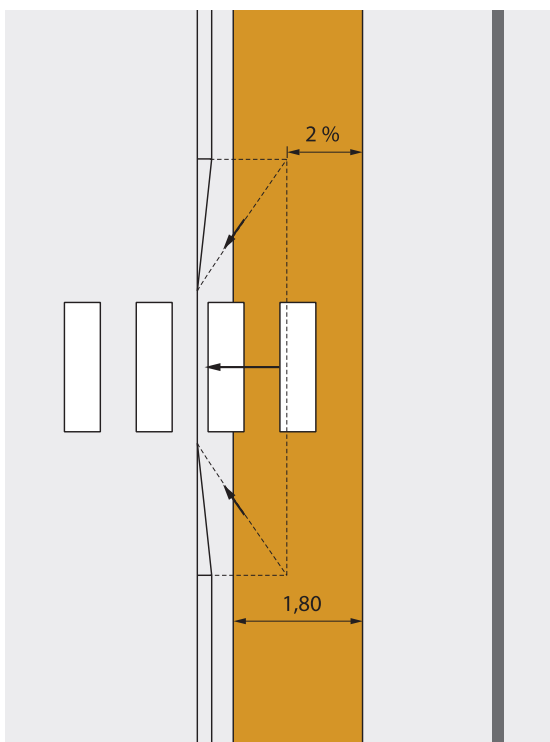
Piste cyclable à hauteur d'une traversée piétonne, vue d'en haut.
